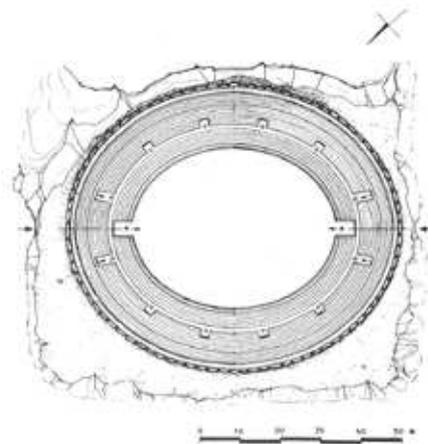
Pianta dell'anfiteatro di Sutri.
